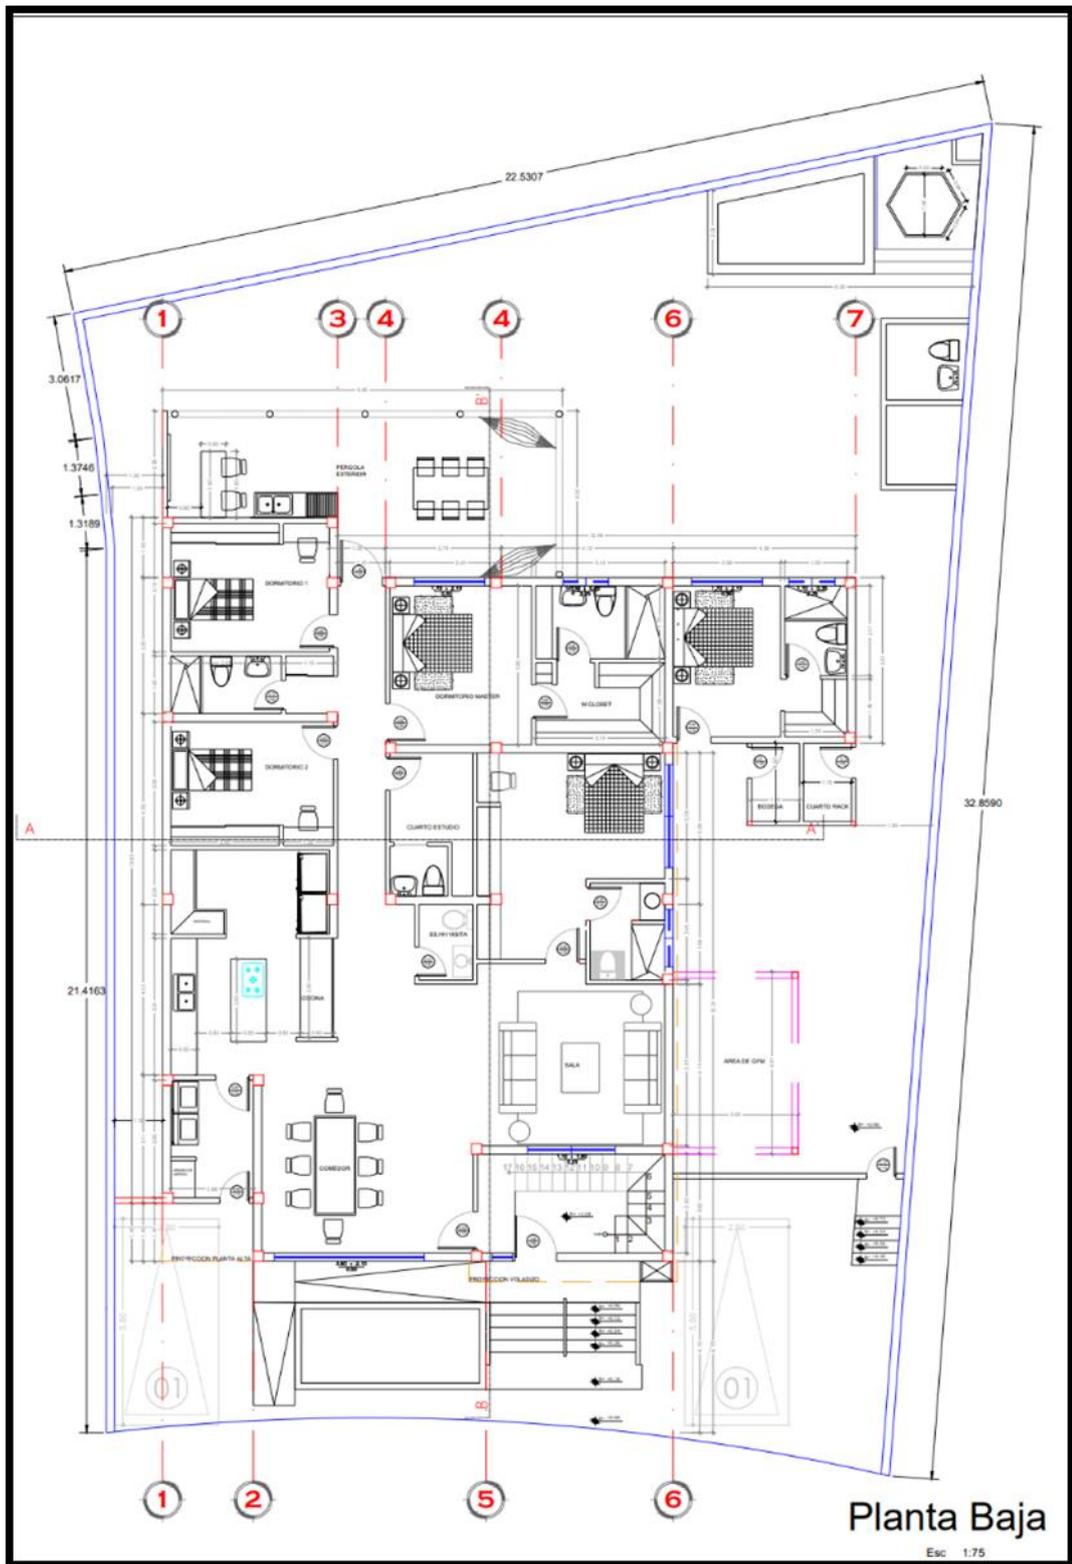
Plano referencial de la planta baja, de la vivienda #1.
